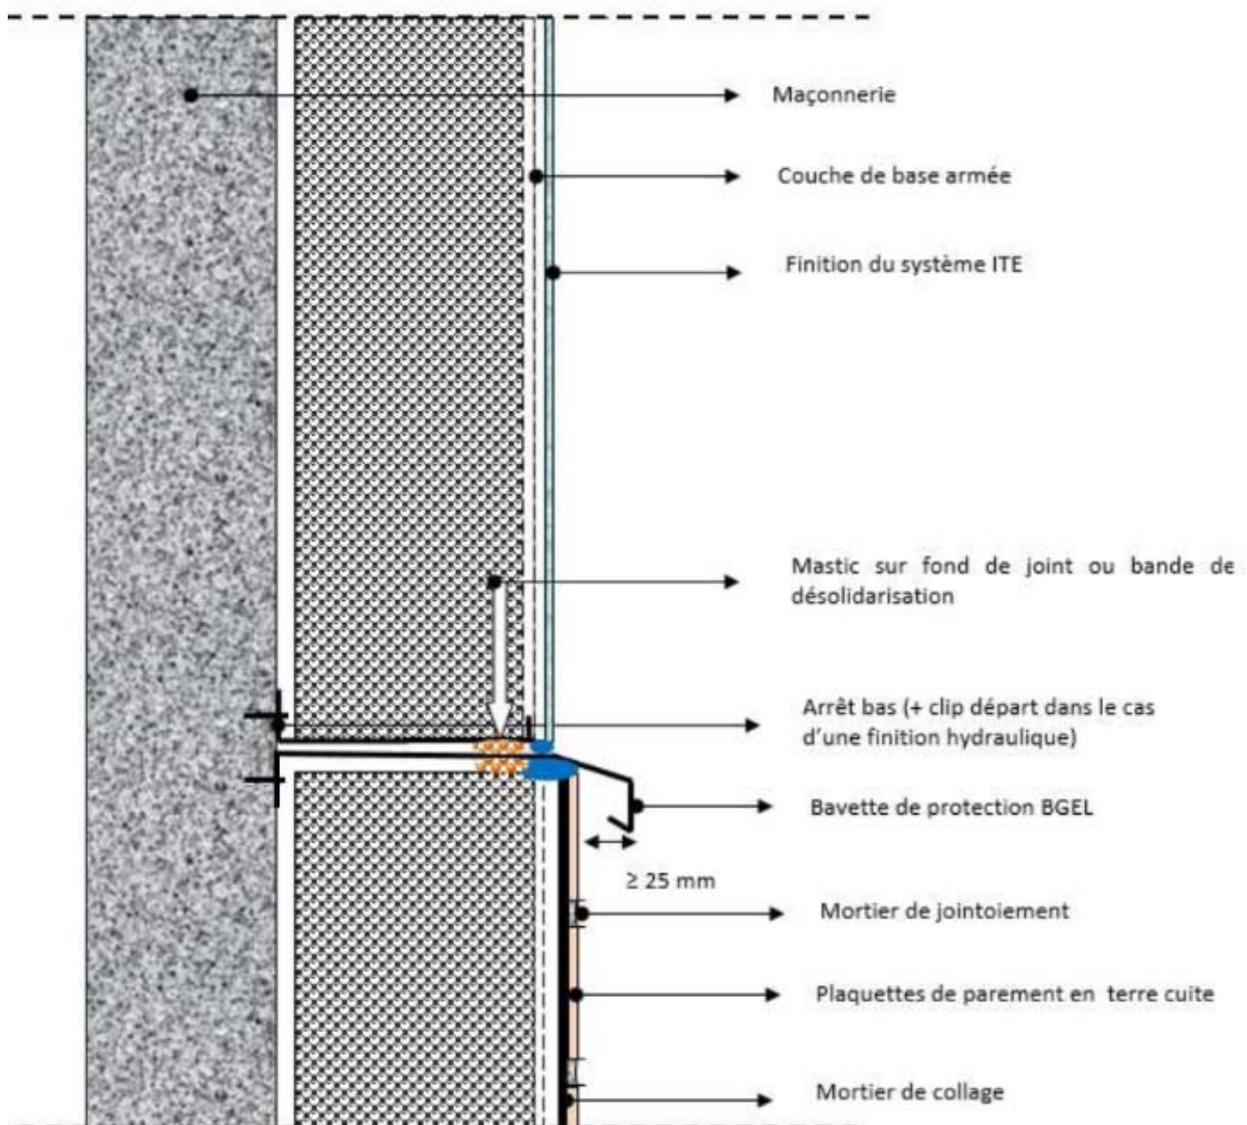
Finitions plaquettes de parement en terre cuite : raccordement avec un système d'enduit sur isolant avec utilisation d'une bavette (la fixation des panneaux isolants sur la maçonnerie n'est pas symbolisée)
